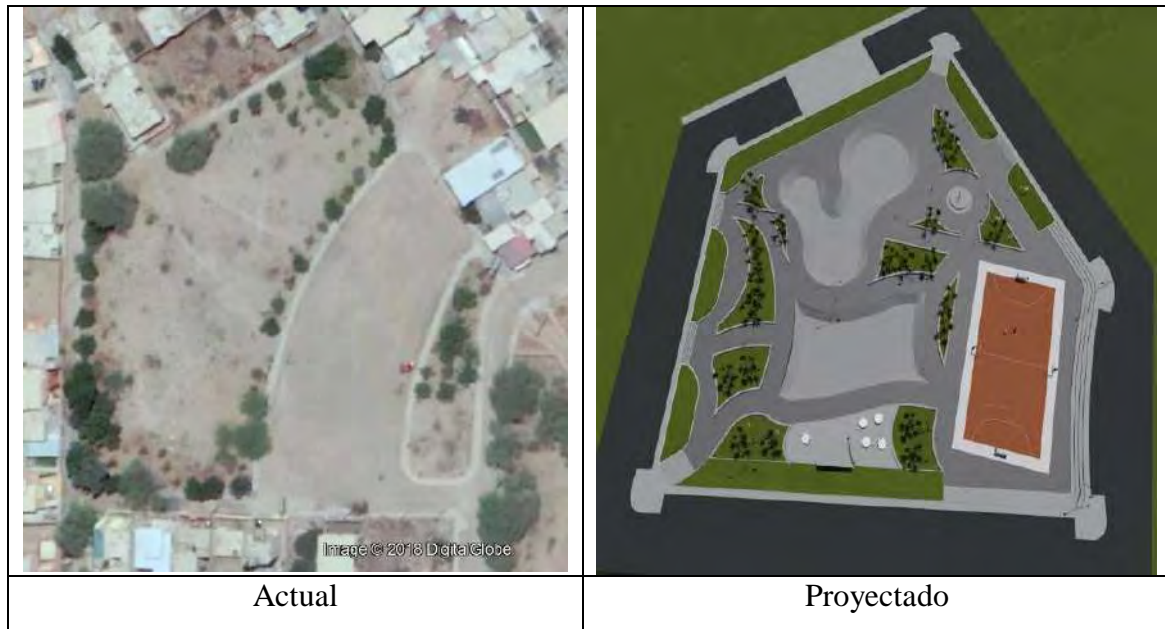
Vista en planta del parque Bello Horizonte (actual y proyectado)
